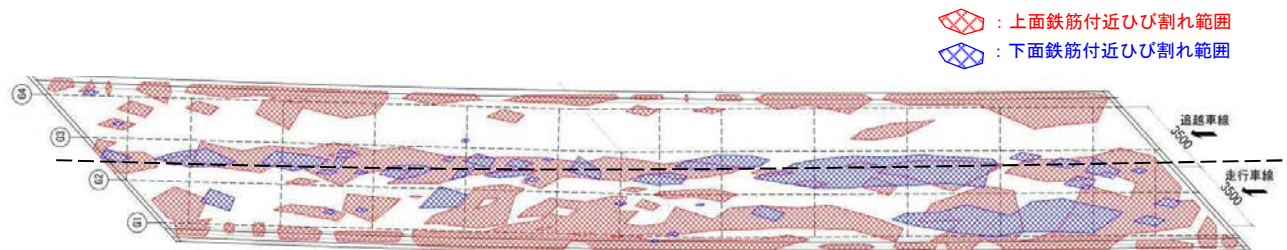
床版内部ひび割れ図 (床版切断面ひび割れから推定)
